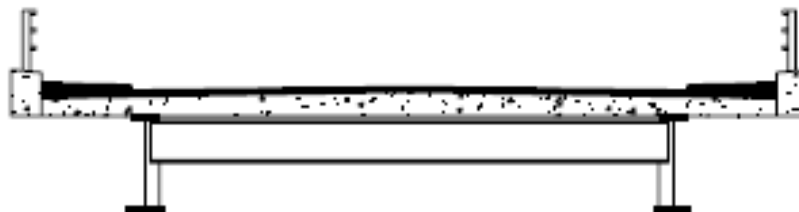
Seção transversal tipo da solução com carlingas que apoiam a laje
